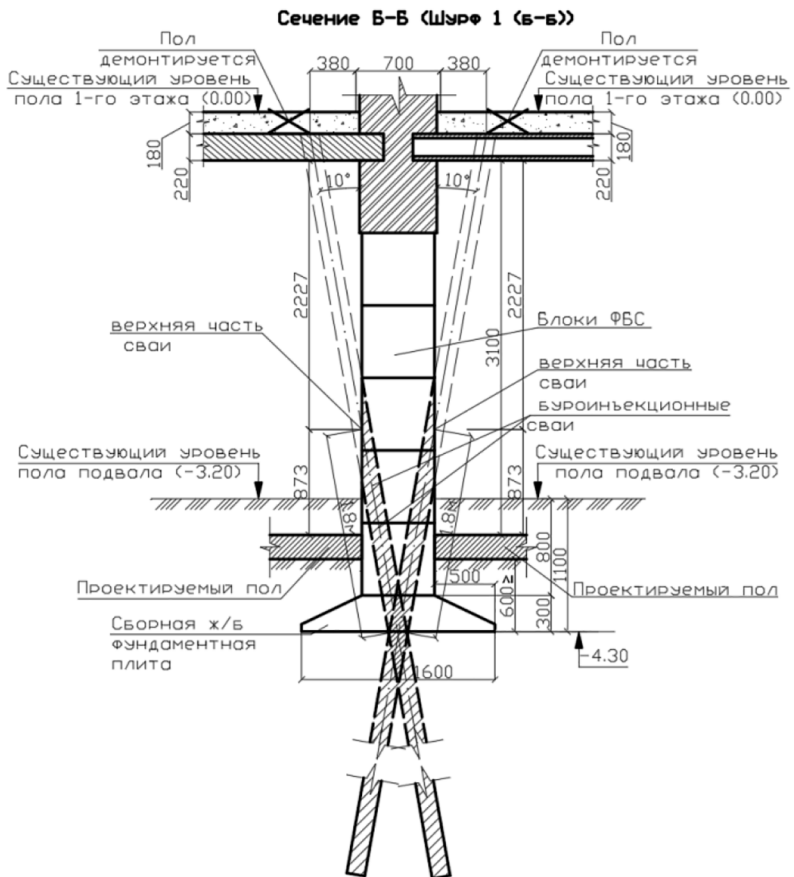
Поперечное сечение Б-Б усиленного основания фундамента
